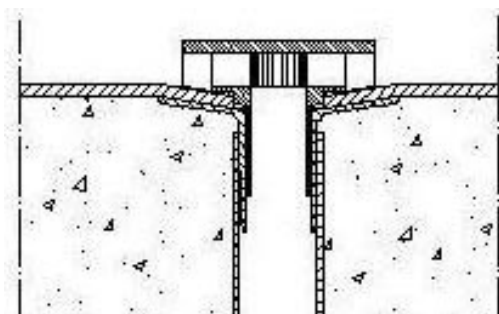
Grundavloppsrör rätt monterad, 15 mm under färdig betongövertya.
